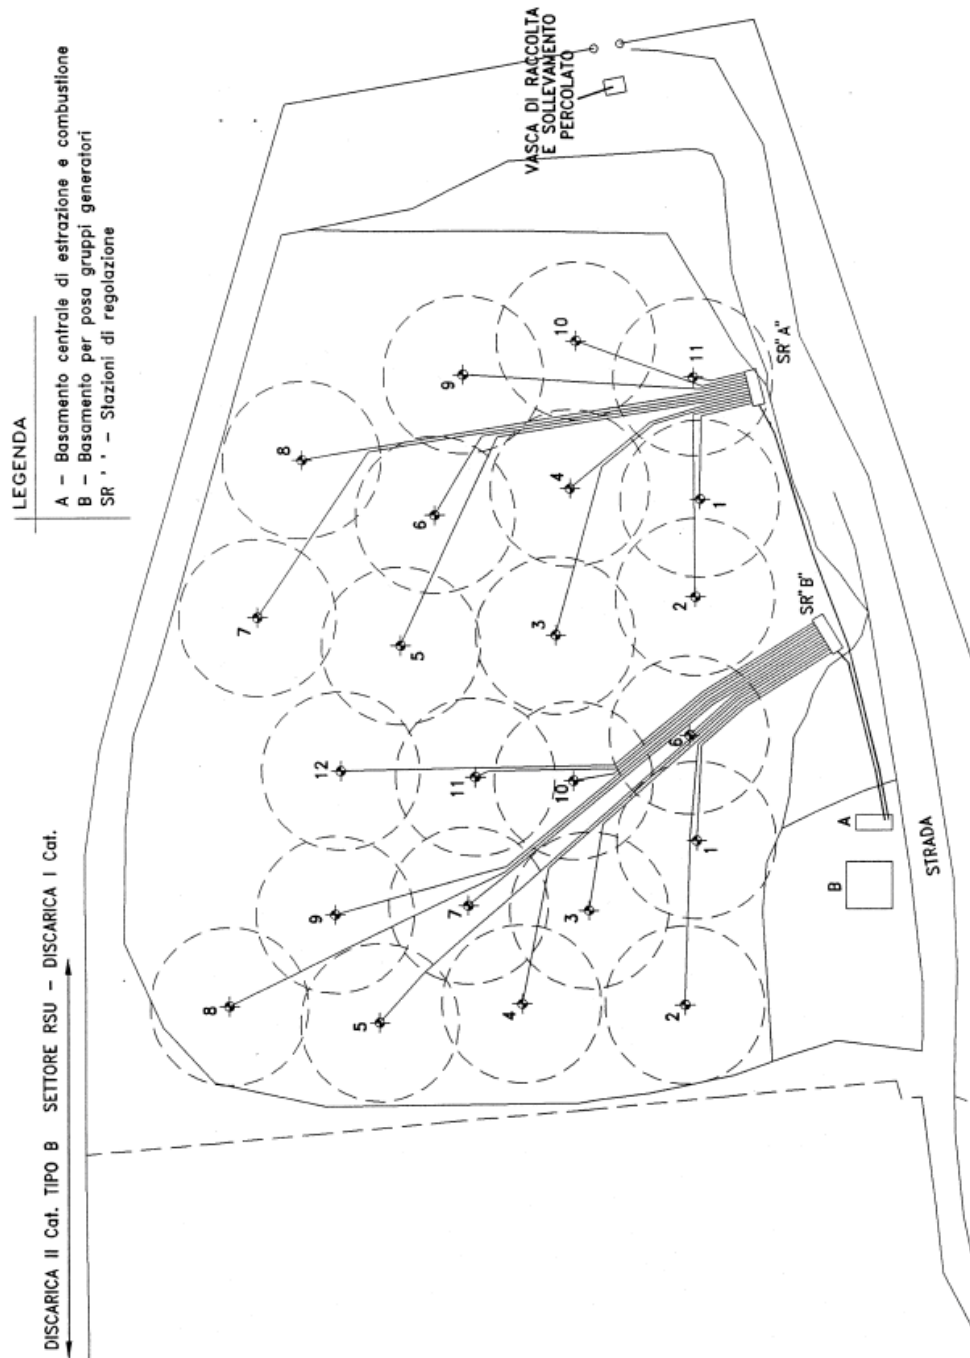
Planimetria del sistema di captazione del biogas³⁰
